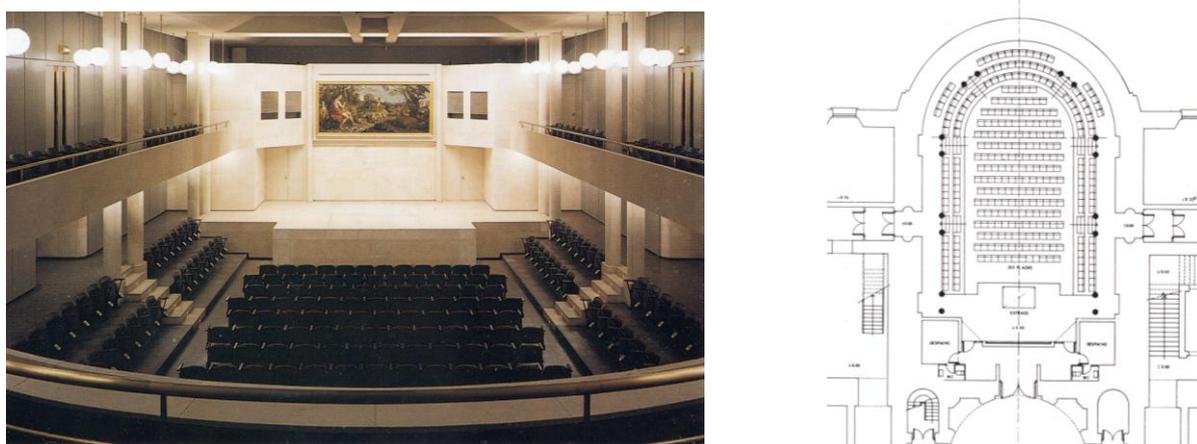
Sala Juan de Villanueva: fotografía y plano de planta (cota 0,00)
